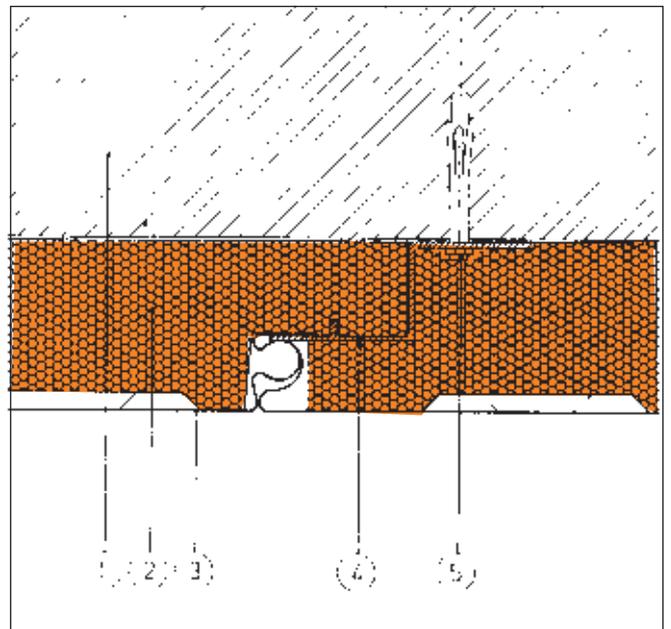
Ancoraggio del rivestimento al supporto mediante profilo metallico - Sezione corrente orizzontale - giunto orizzontale
